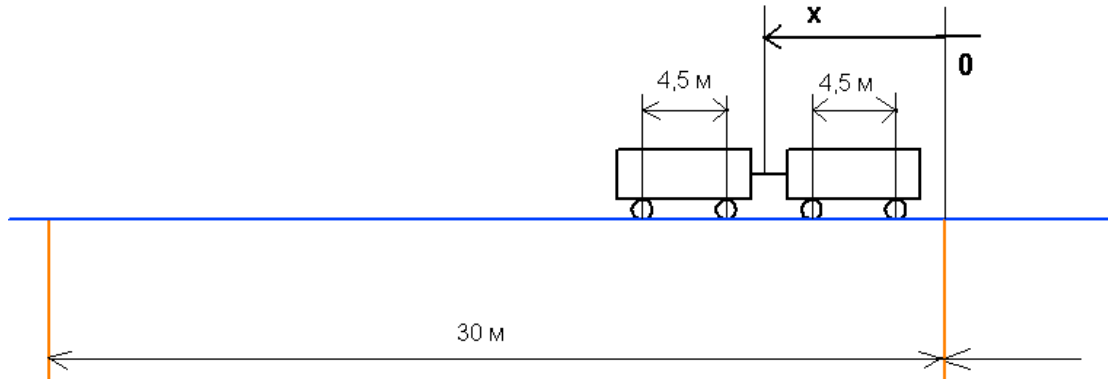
Координаты расположения двух юнибусов на пролете (для расчета на прочность рельсо-струны при шарнирном закреплении корпуса рельса на промежуточной опоре)
